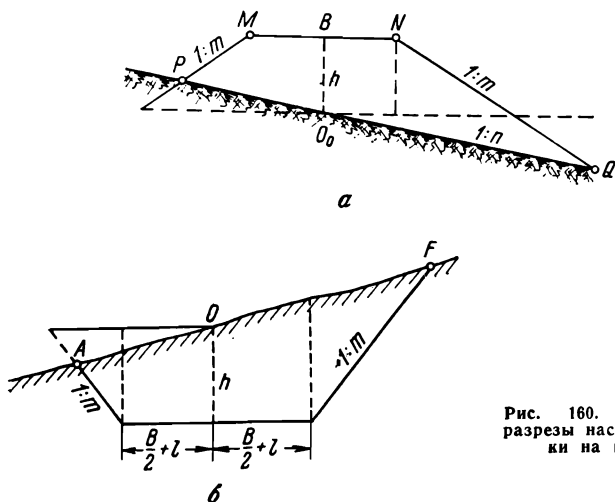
Поперечные разрезы насыпи и выемки на косогоре
